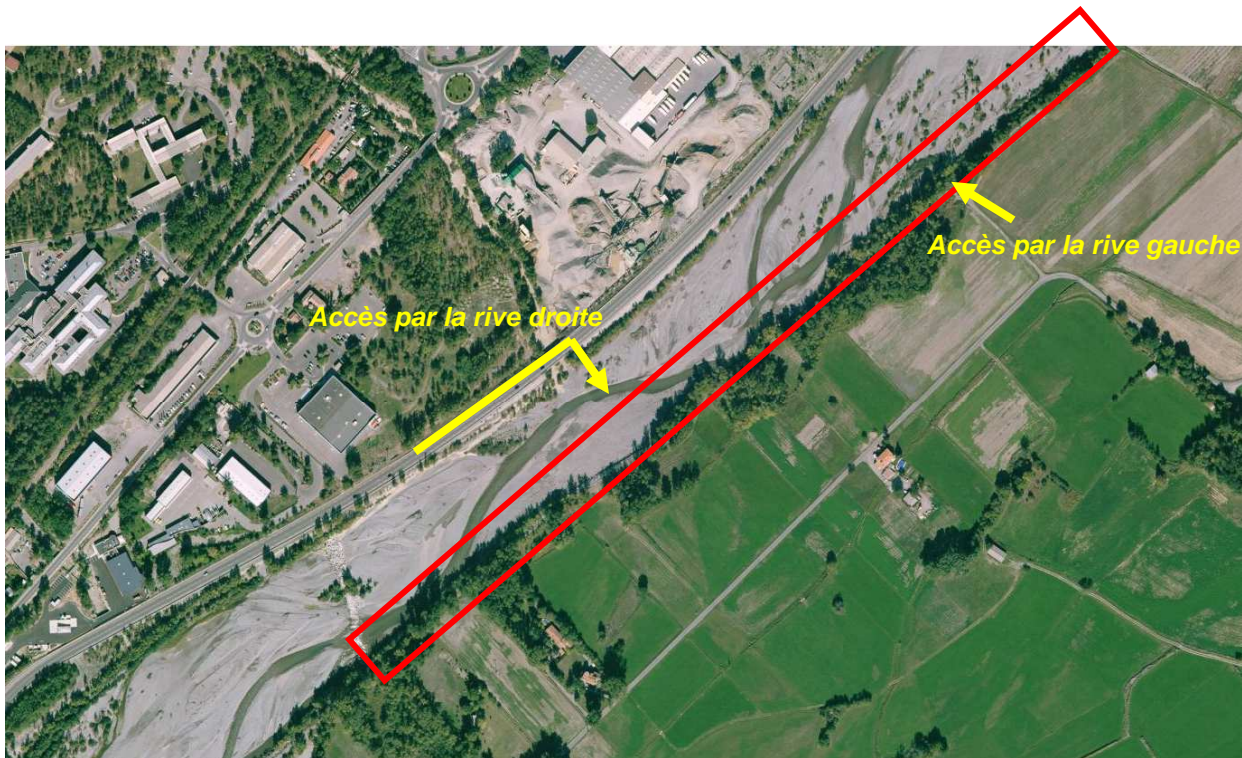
Accès et installation de chantier pour les travaux de confortement de la digue du plan d'eau des Ferréols (amont seuil de la canalisation) et des protections du Plan de Gaubert
